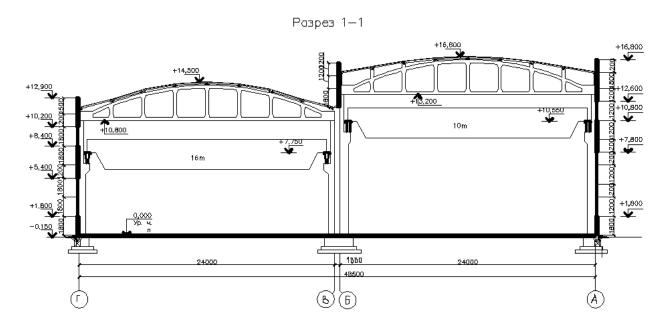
Поперечный разрез 2-х пролетного одноэтажного промышленного здания
